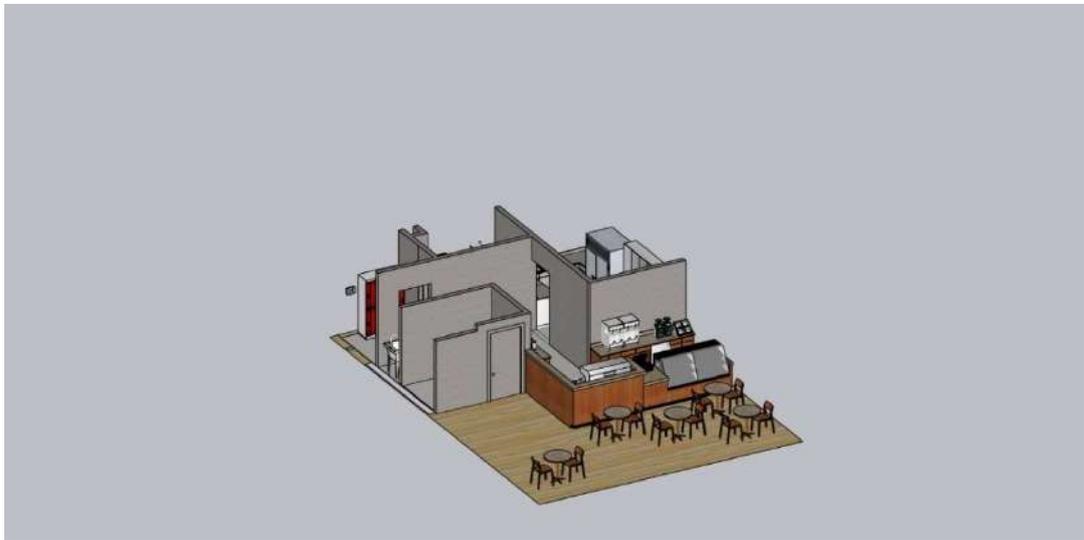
Primeiro Pavimento Café anexo ao Teatro-Escola Villa-Lobos.
